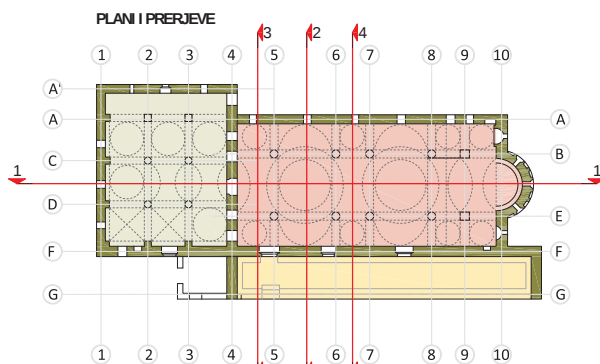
Planimetria e kishës (prezantimi i Grupit 3)
